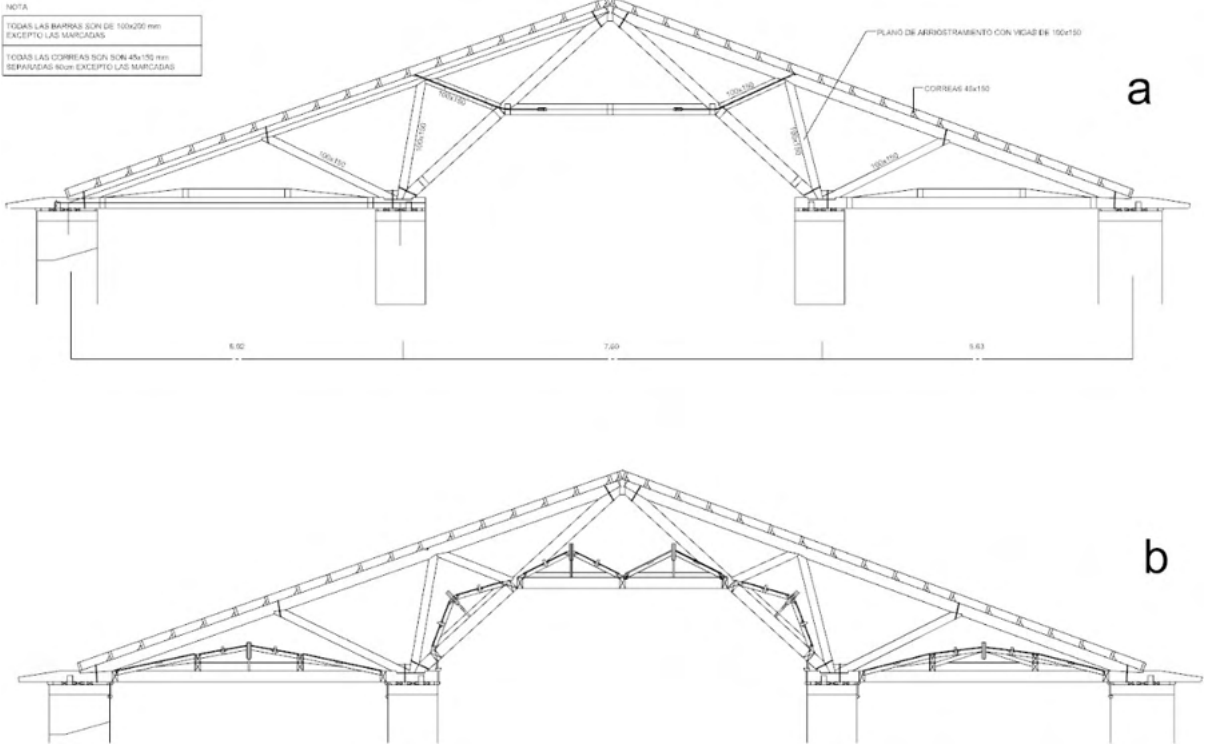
Alzado sección de la armadura; a) armadura principal; b) armadura completa con casetones
